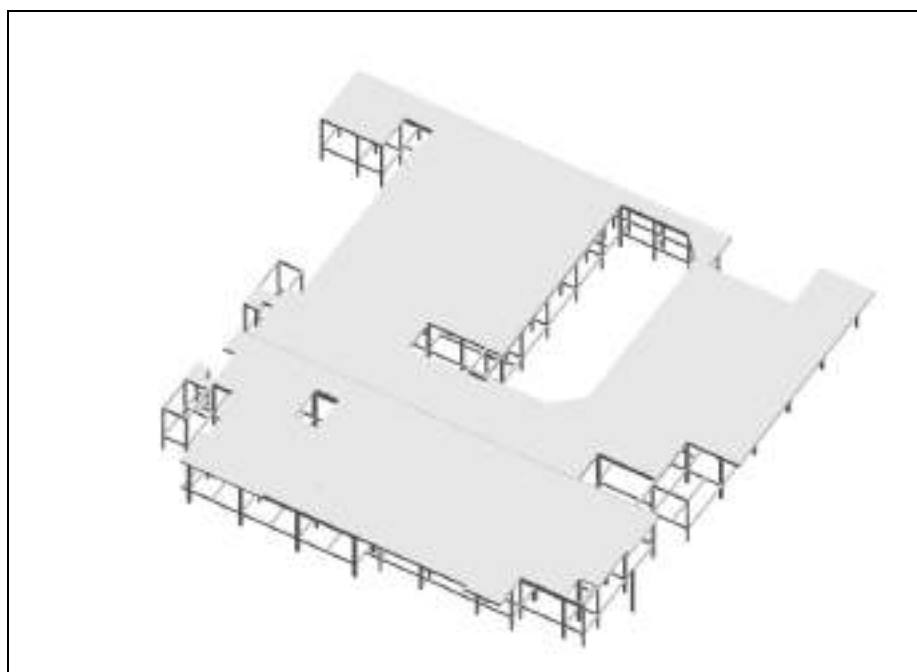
Revit -Vista 3D Modelado de sistema de losa aliviana (Primer piso)
